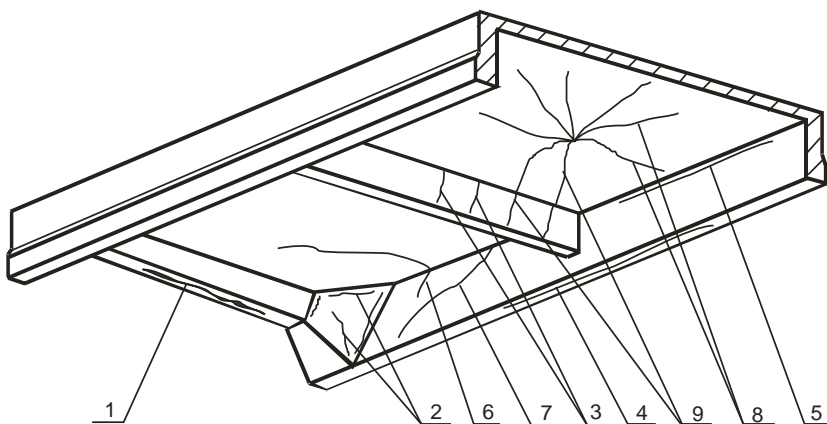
Характерные трещины ребристой плиты перекрытия (покрытия): 1 – продольные по поперечным ребрам; 2 – различного характера по «вуту»; 3 – нормальные по поперечным ребрам; 4 – продольные в продольном ребре; 5 – горизонтальные на участке перехода полки в продольное ребро; 6 – наклонные по полке, переходящие в продольное ребро; 7 – наклонные по продольному ребру; 8 – наклонные по полке; 9 – наклонные по полке, переходящие в поперечное ребро
